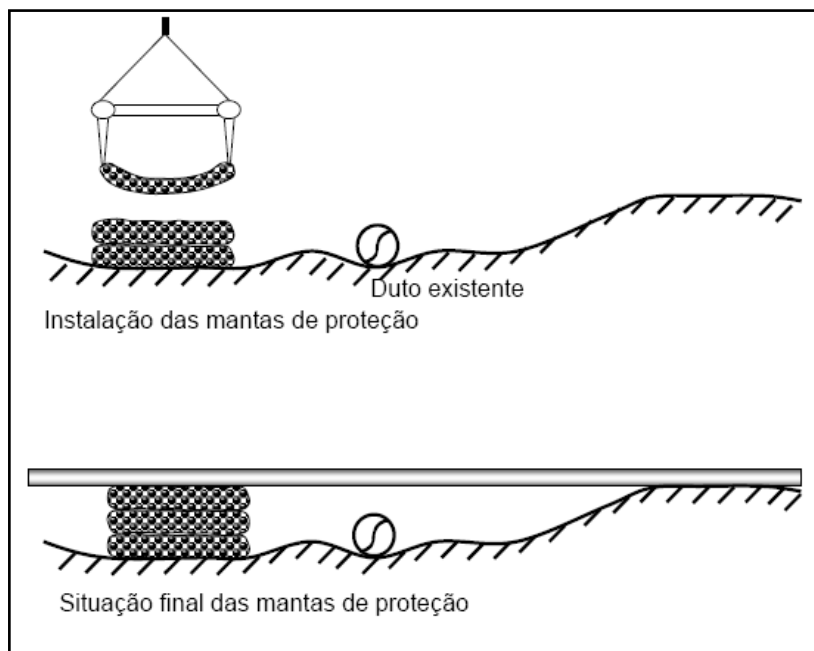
Método de utilização de mantas de concreto.
